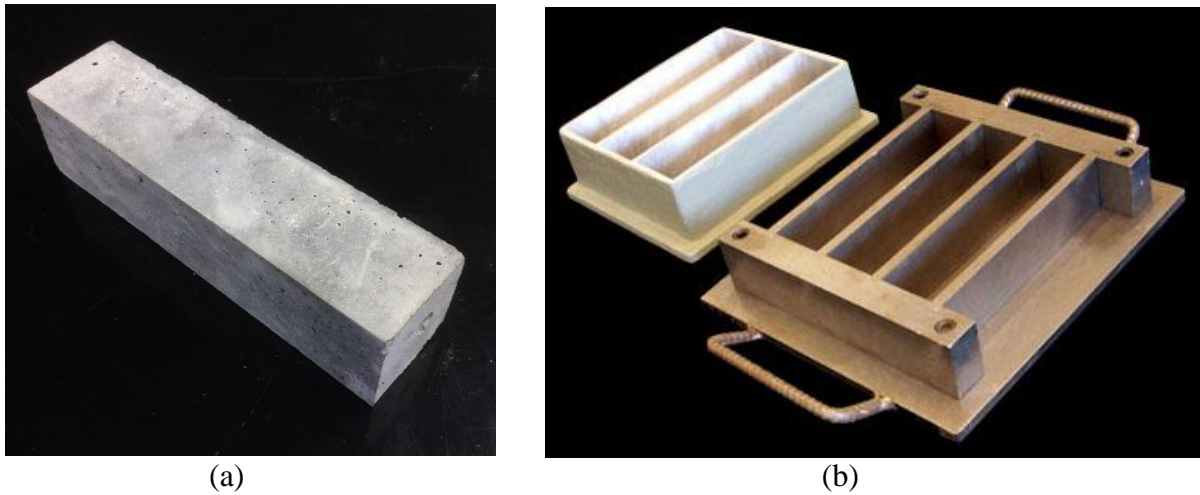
(a) probeta mortero estandarizada, (b) moldaje probeta Rilem
